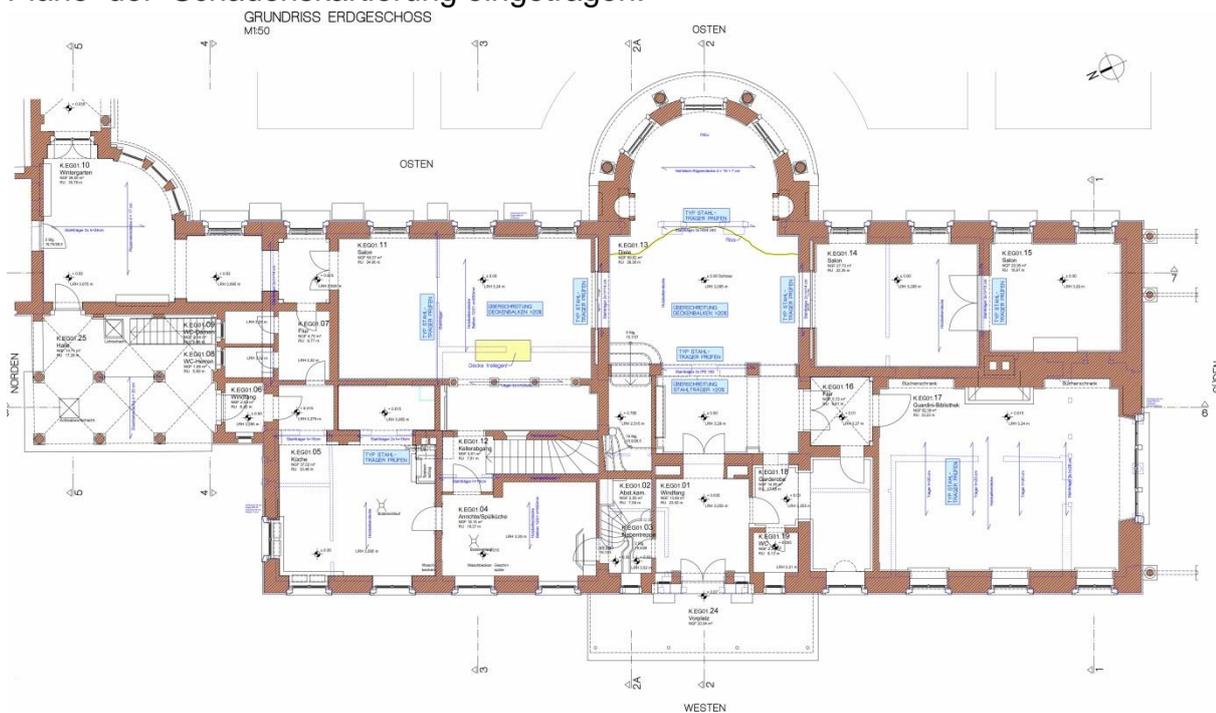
Beurteilung Tragwerk, Grundrissplan Erdgeschoss, Mitternacht beratende Ingenieure
